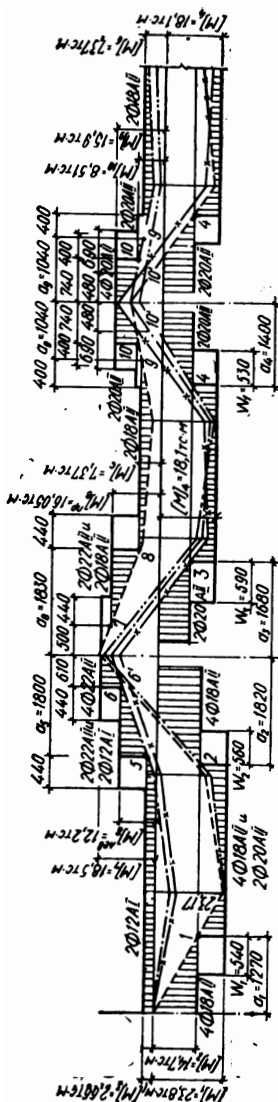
Общий вид армирования главной балки, конструкции каркасов и эпюры материалов.
